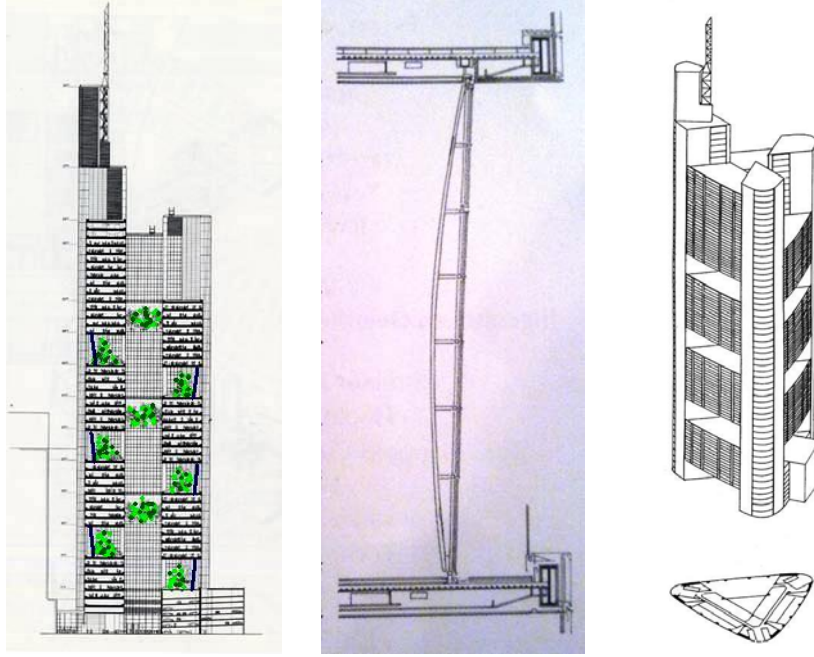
Commerzbank Kat Planı¹⁸³
